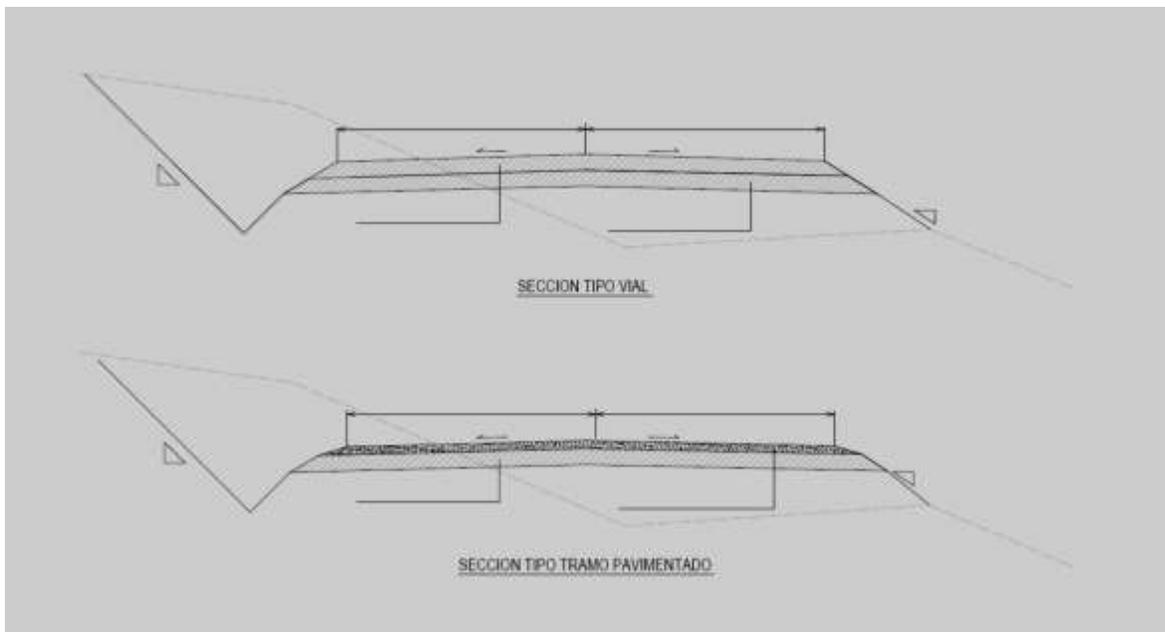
8. Secciones transversales de la vía con y sin pavimento
